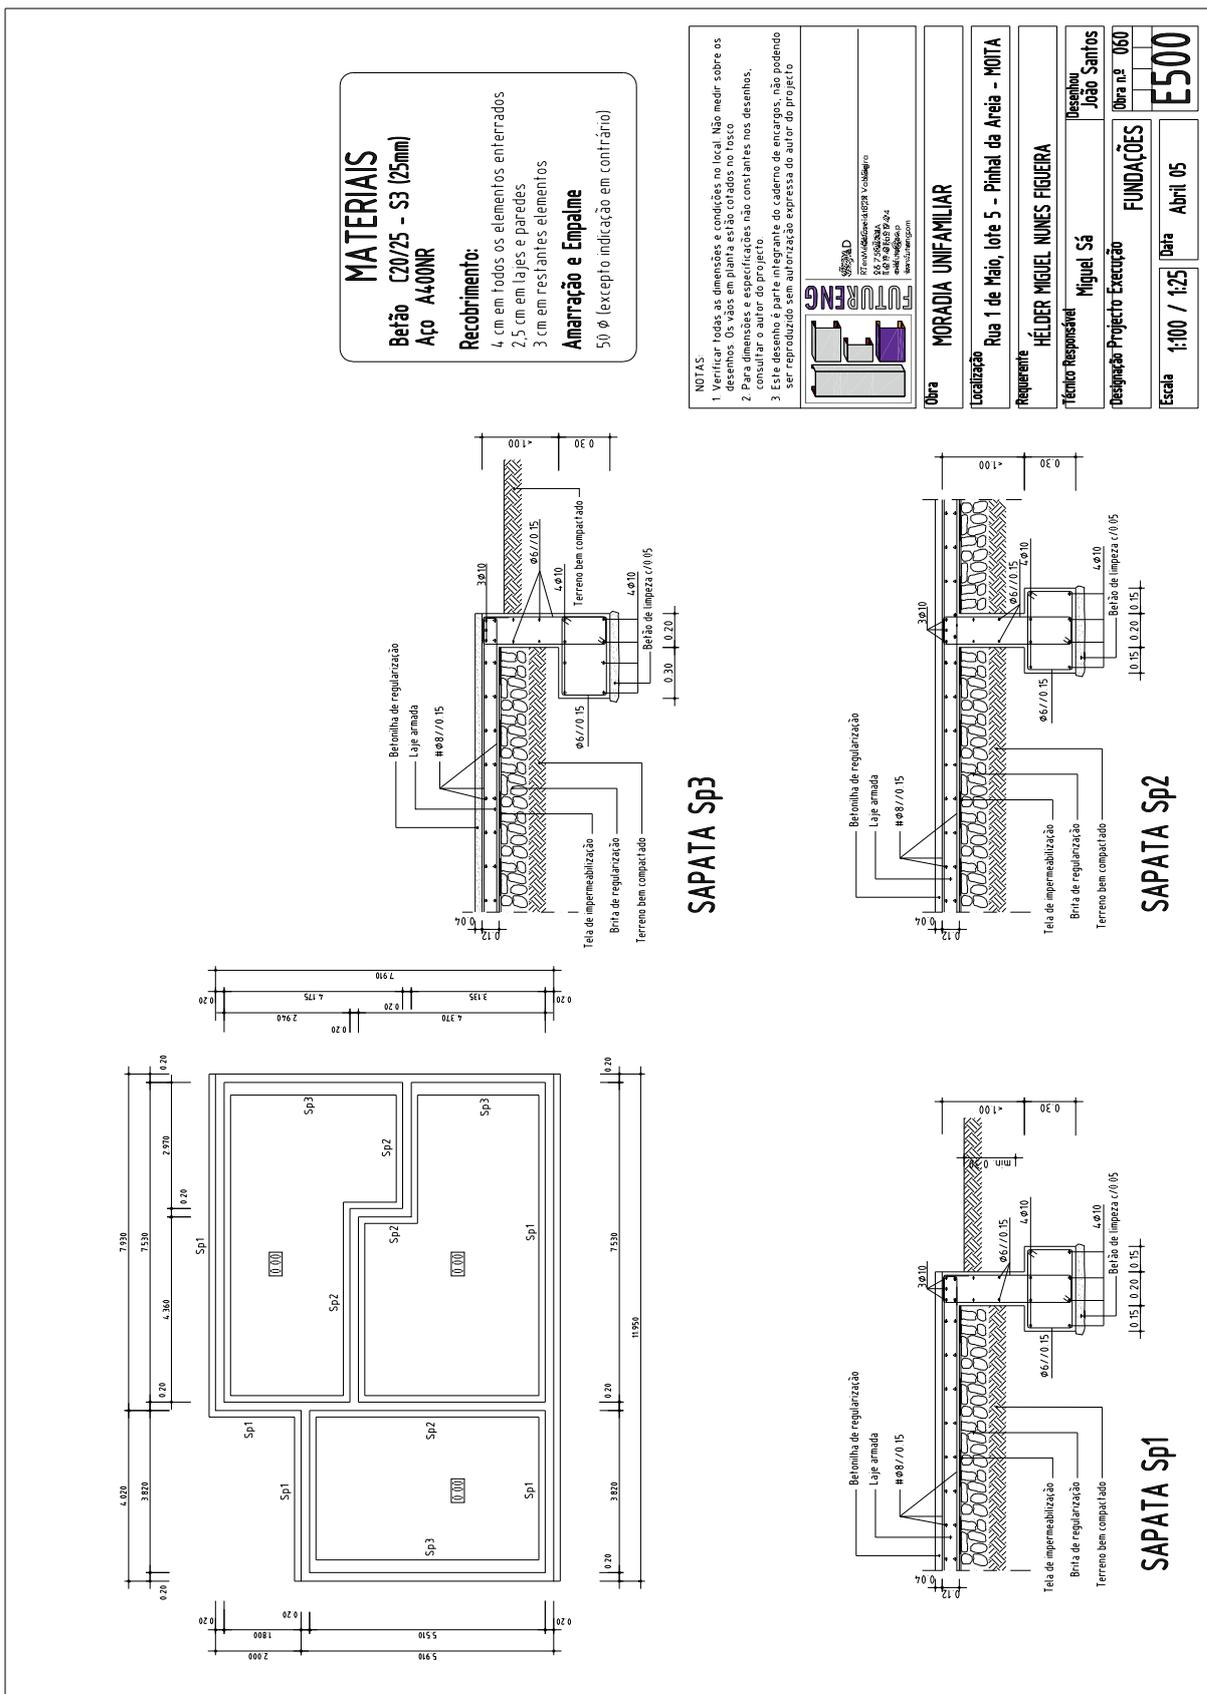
Planta estrutural de fundações com pormenores da solução em LSF
